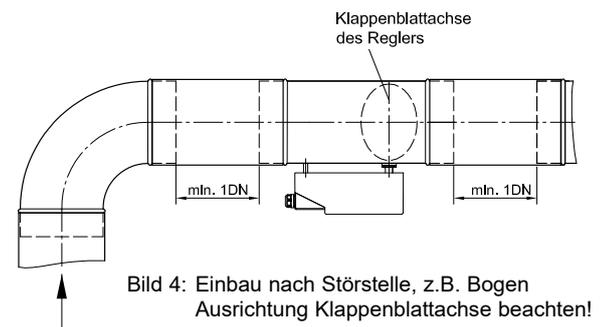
Einbau nach Störstelle, z.B. Bogen
